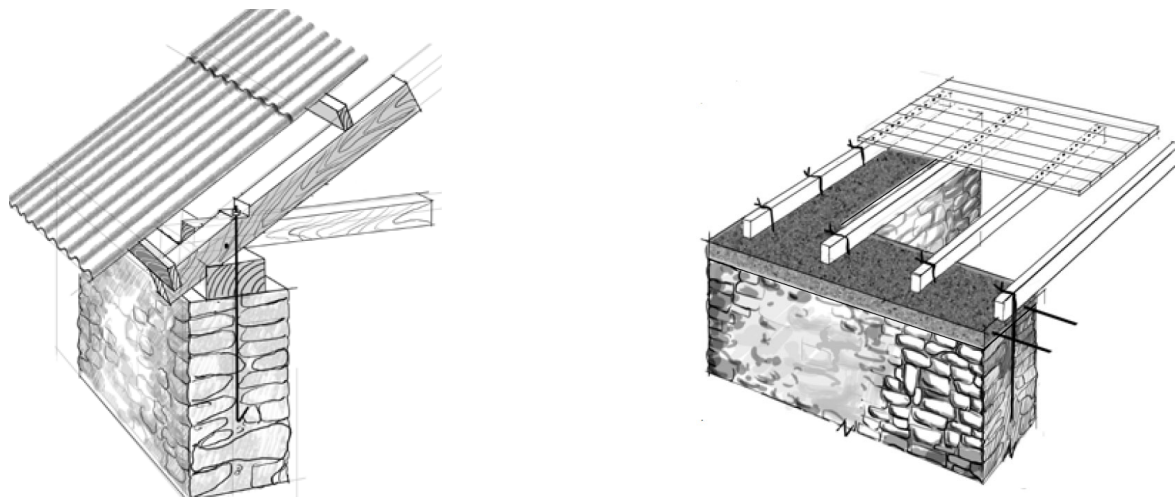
Verbindung der Fassade mit der Dachkonstruktion [33]
